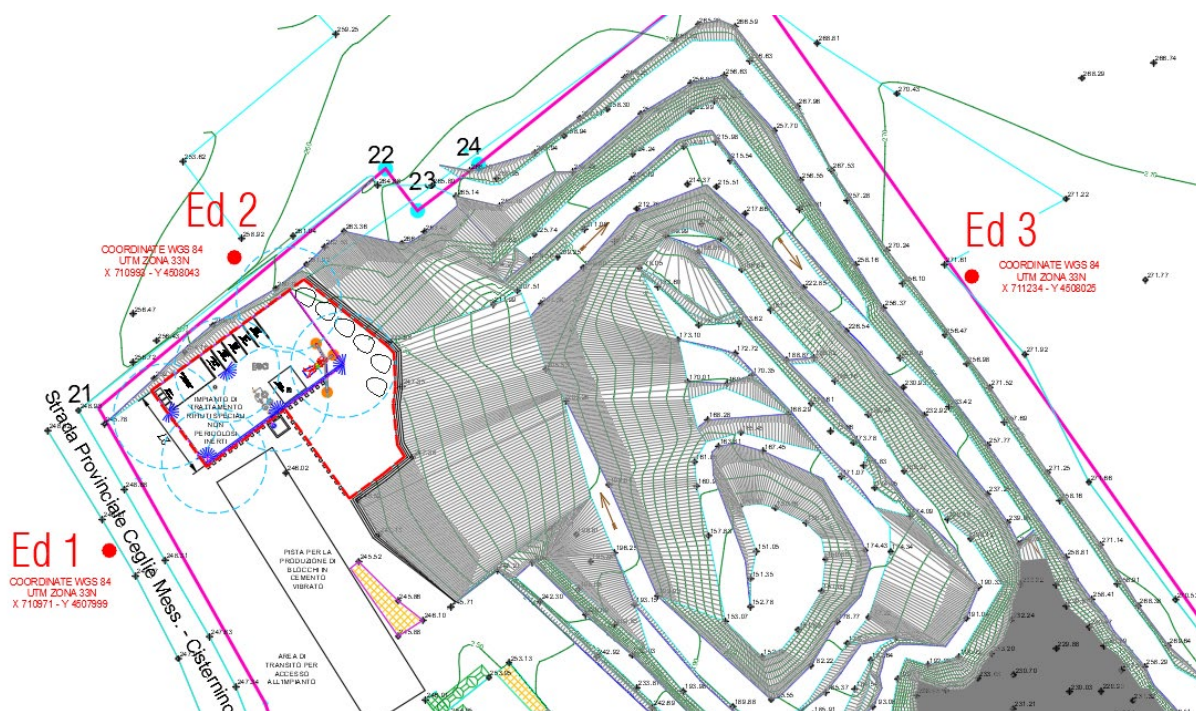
planimetria con la posizione dell'impianto e dei nuovi punti di campionamento delle emissioni diffusi.
